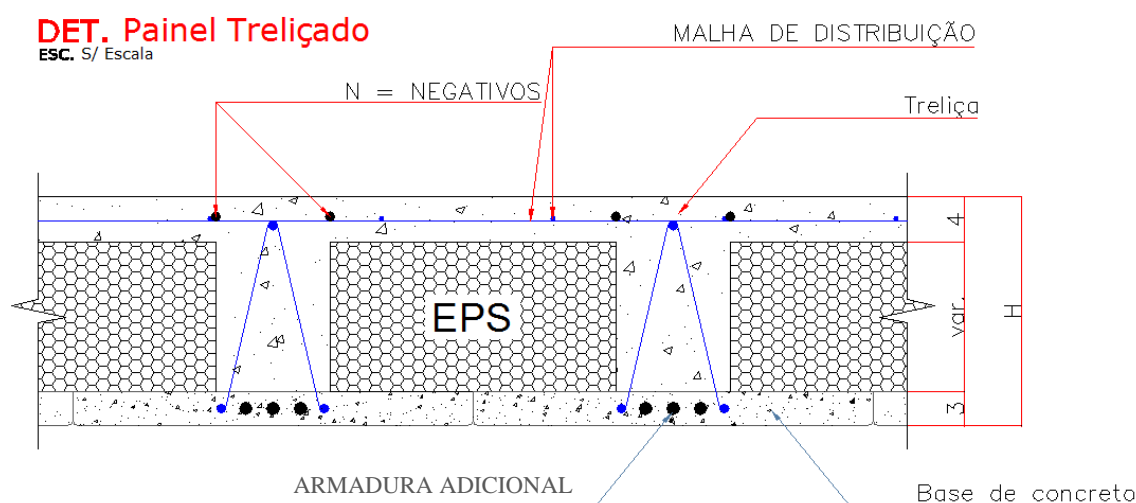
Tipo de treliça utilizada nas pré-lajes.
